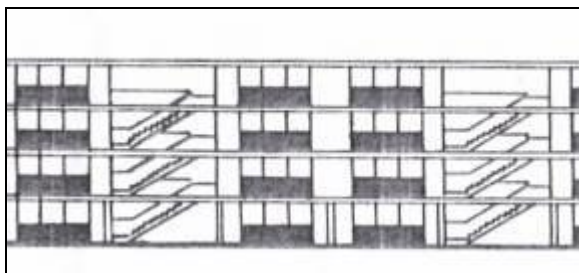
e. Bloque bajo (escalera longitudinal interna). F. (1954)
